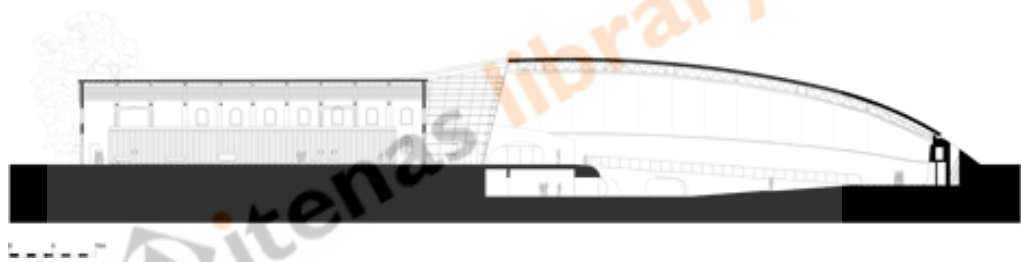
Floor Plan *Enzo Ferrari Museum
